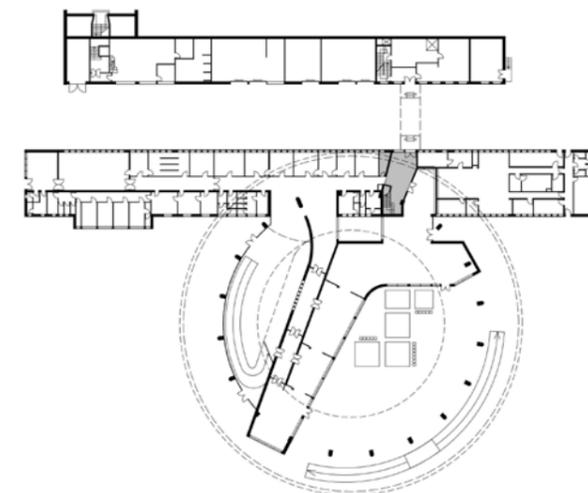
Treppenhaus und Raum 14 im Grundriss, EG
